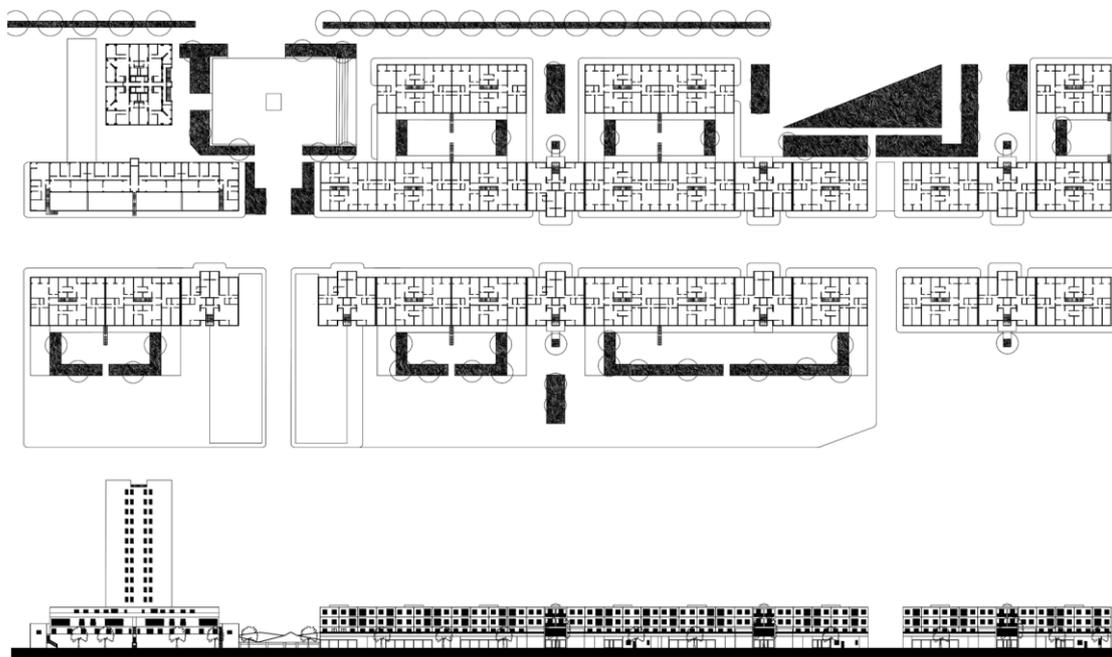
| Pianta piano tipo. Prospetti sud-ovest su via Franciosa.
